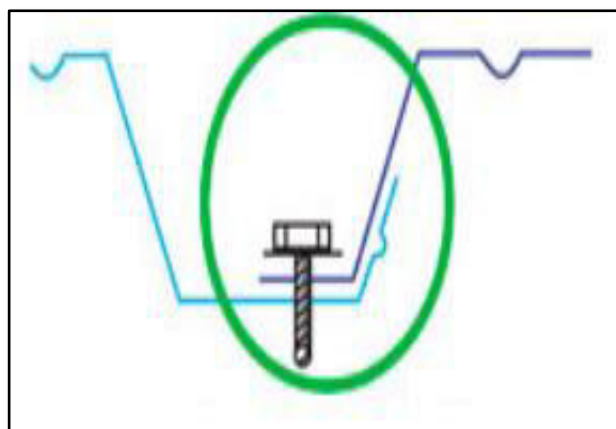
Detalle del traslape transversal (Kubiec)
